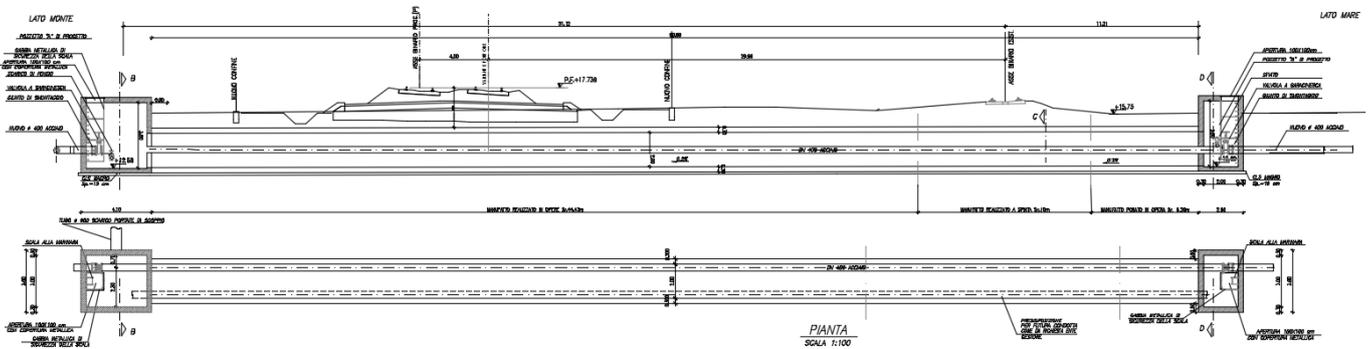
Sezione longitudinale attraversamento ferroviario.
